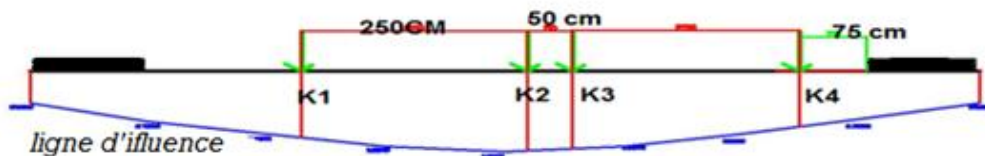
disposition du Bc deux files pour la poutre centrale
